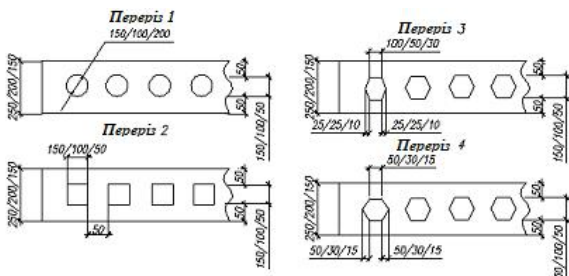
Конструктивні схеми плит перекриттів з різними формами перерізу пустот : переріз 1 – коло, переріз 2 – квадрат, переріз 3 – неправильний шестикутник, переріз 4 – правильний шестикутник / Fig. 1. Structural charts of flags of ceiling with the different forms of section of emptiness : type 1 – a circle, type 2 – a square, type 3 – hexagon, type 4 – correct hexagon
